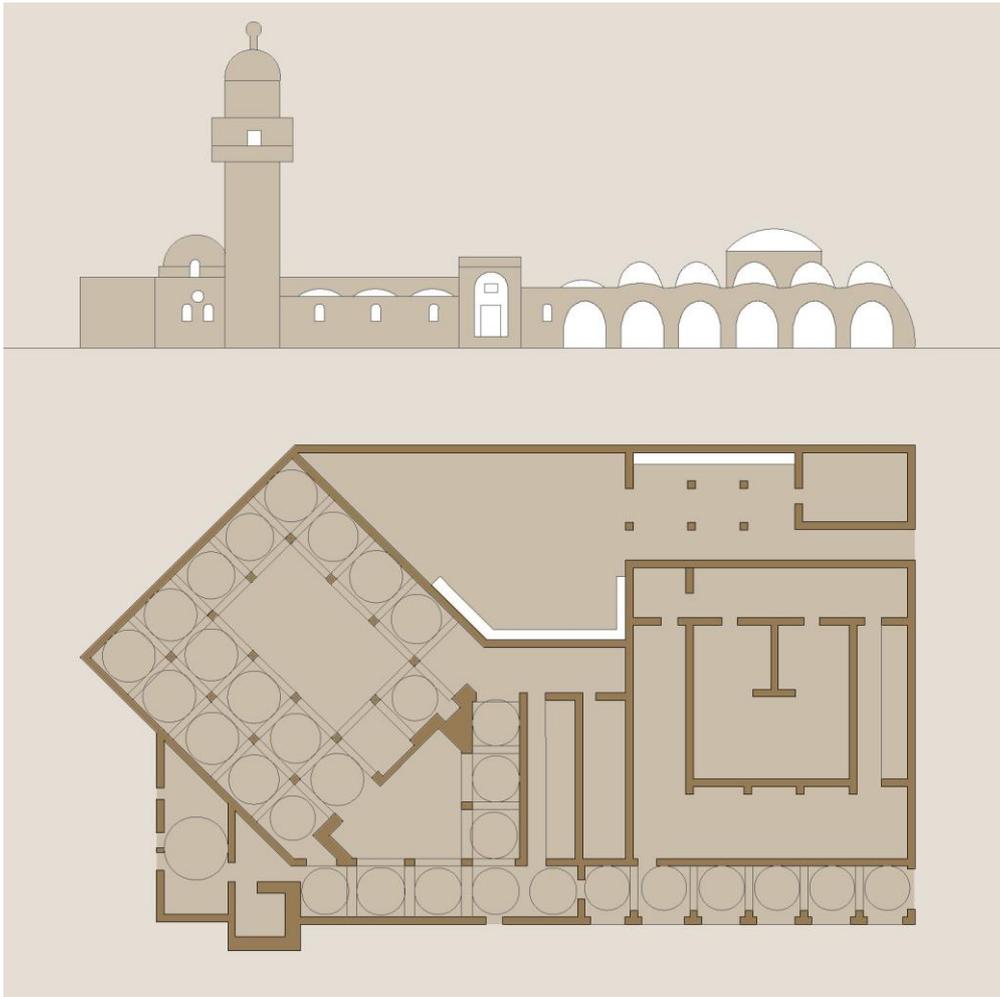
Planta y alzado de la mezquita de Nueva Gourná
